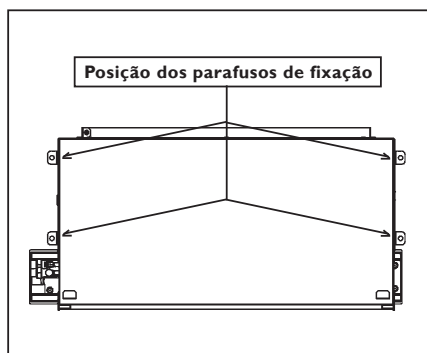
MONTAGEM DO SUPORTE DE FIXAÇÃO
